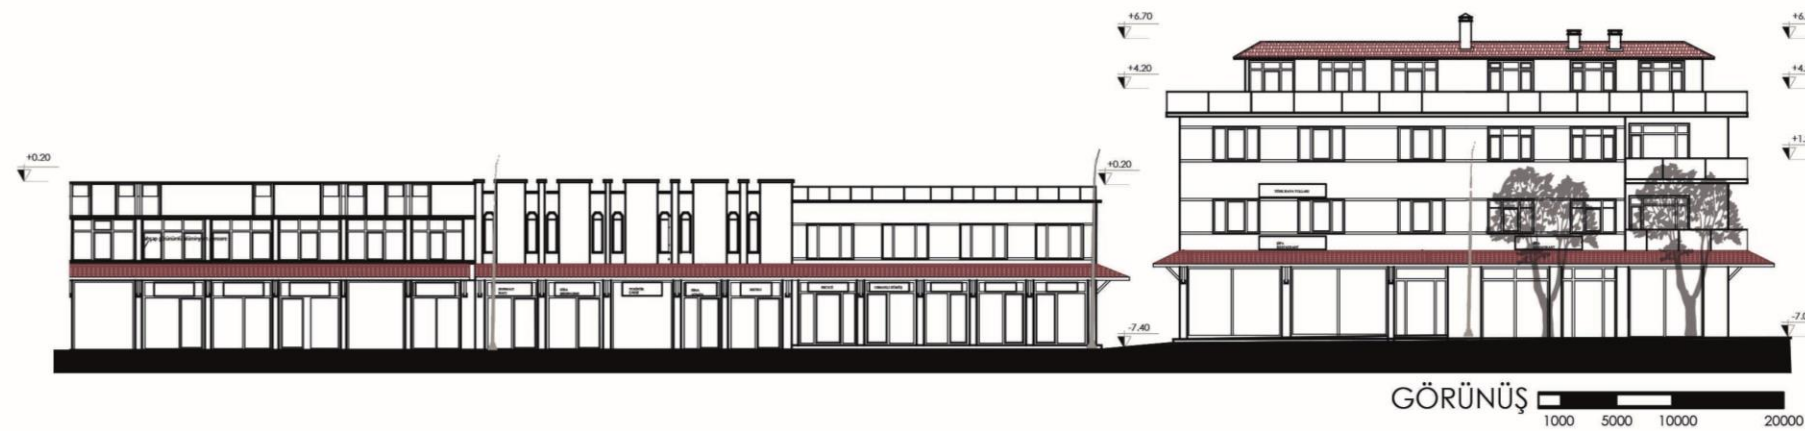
Mekân bölümü 7 plan, kesit, görünüş, fotoğraflar ve deneyim yürüyüşü raporu
